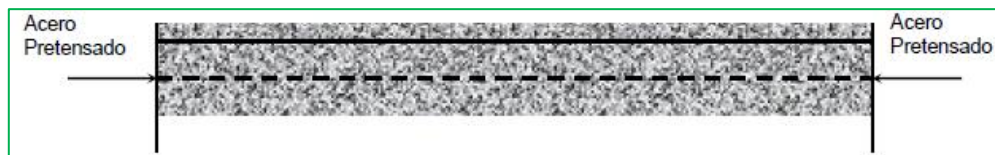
Pavimento Pretensado. Fuente: Pavimentos de Concreto para carreteras. (Ref. Bibliografía 5)
